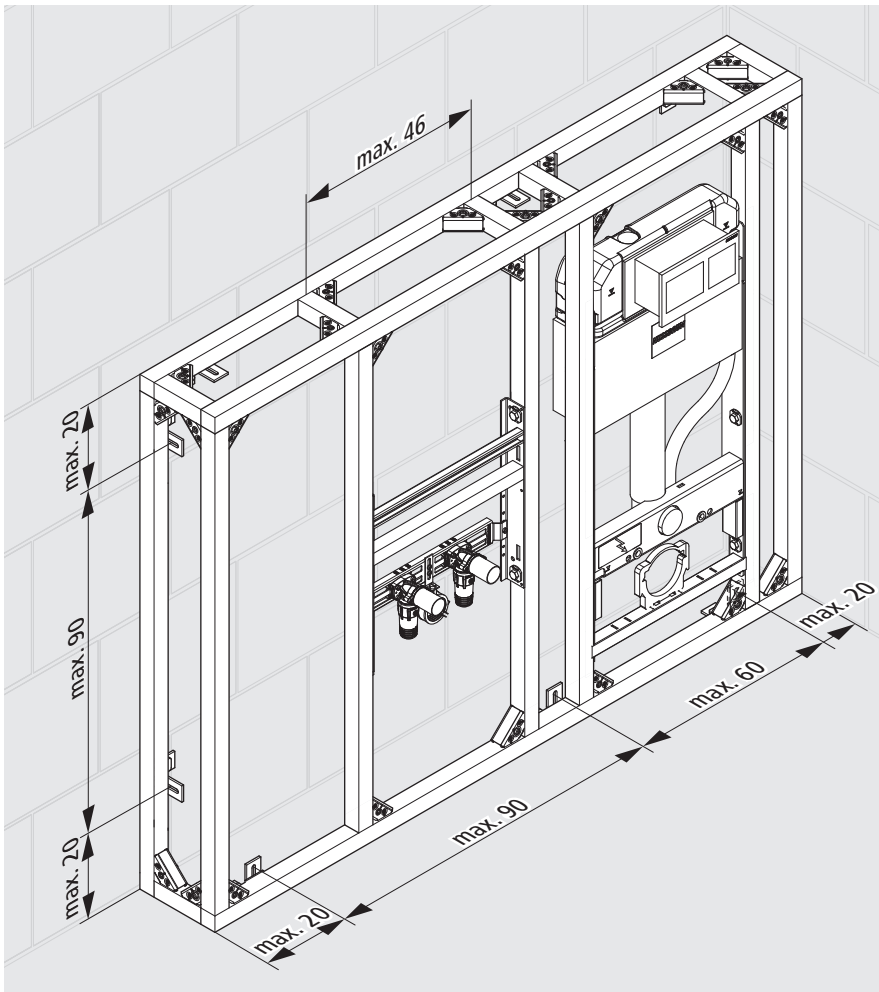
Dimensions de montage cadre de montage hauteur partielle
